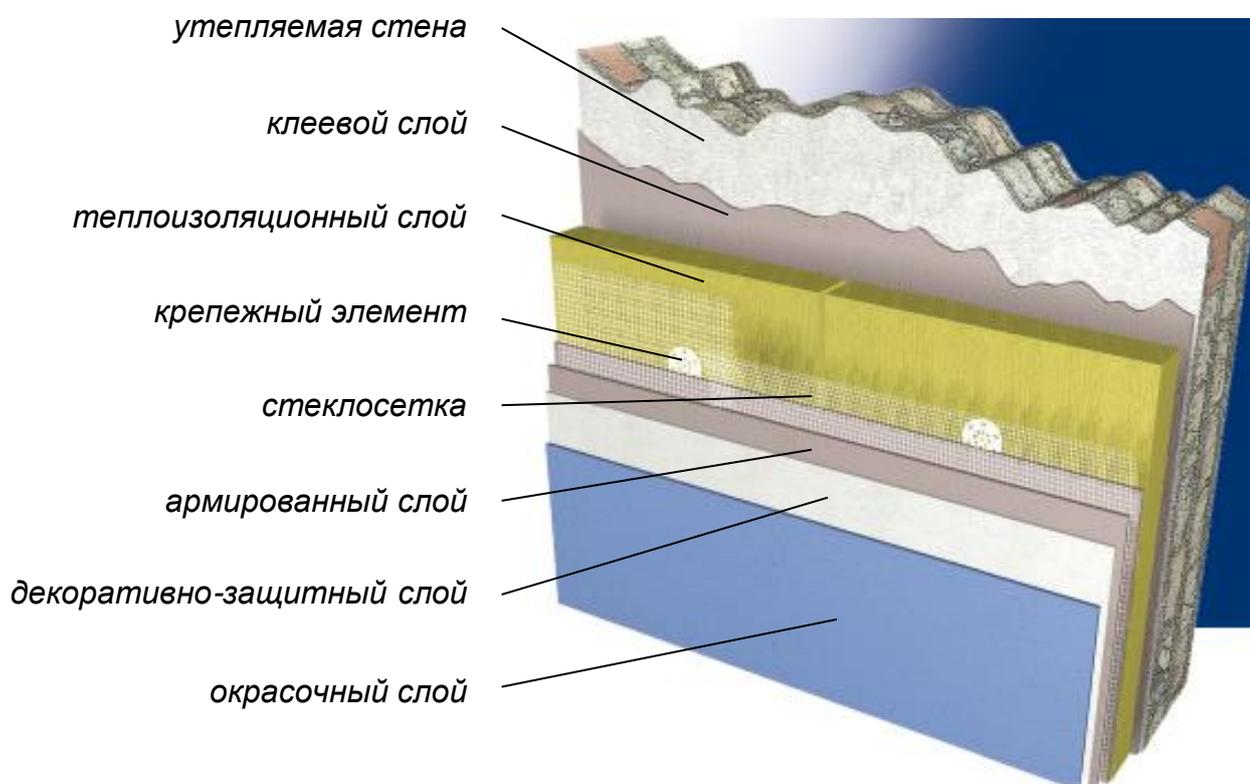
Схема легкой штукатурной системы утепления наружных стен зданий
